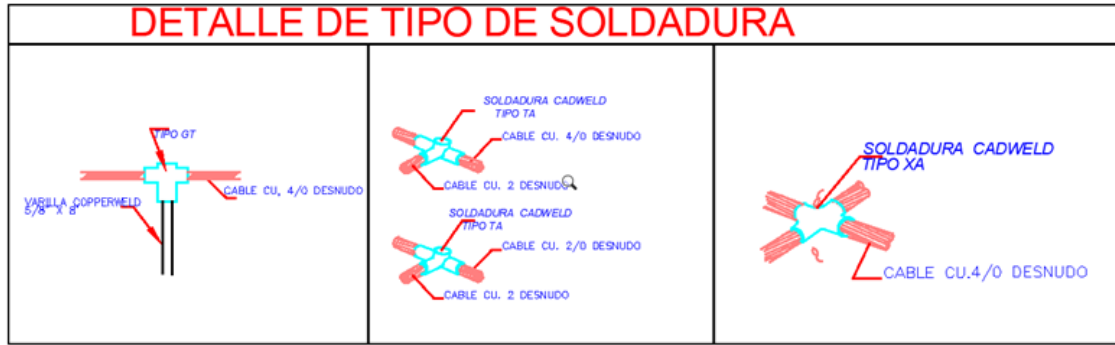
Tipos de Soldaduras;Fuente: Autores
